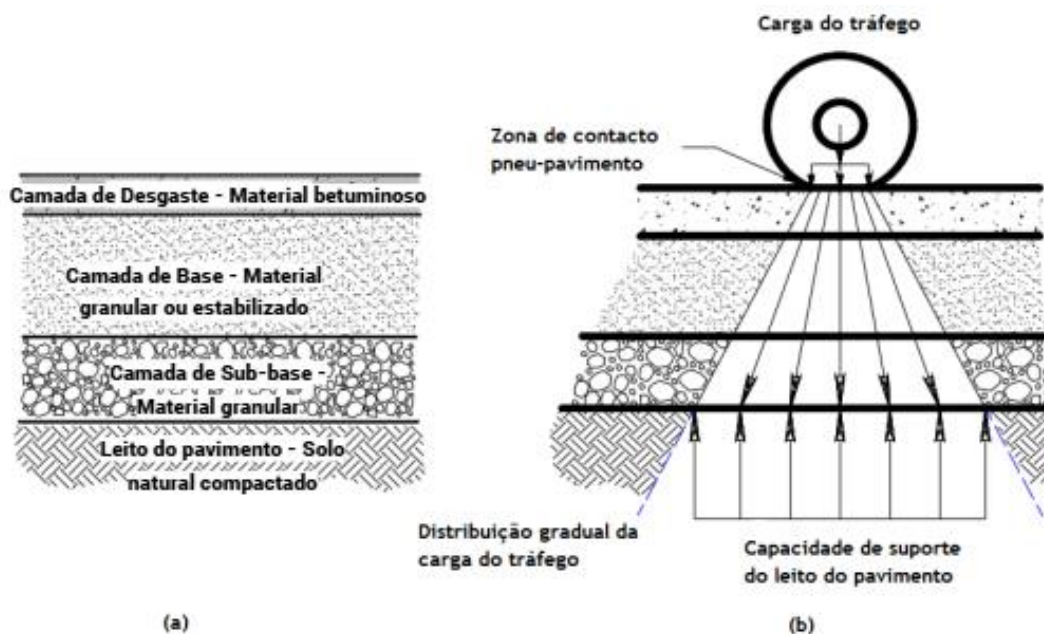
(a) Estrutura típica de um pavimento flexível; (b) Distribuição da carga do tráfego em pavimentos flexíveis (adaptado Lima, 2016).
